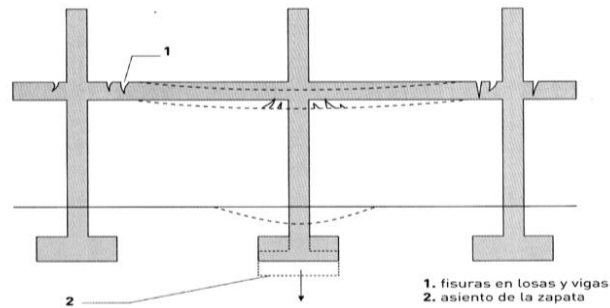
Fisuras en vigas continuas de hormigón armado por asiento de un pilar. Fuente:
